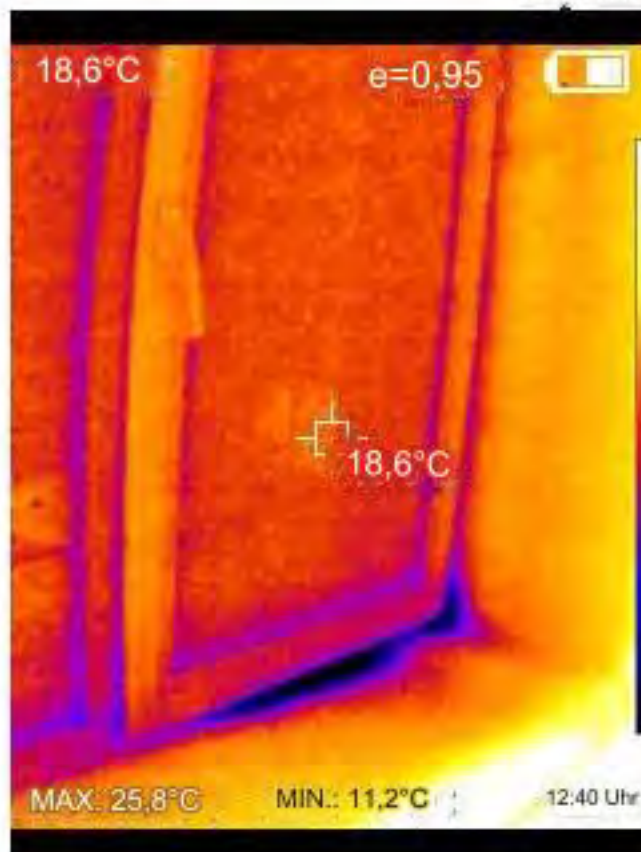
Fenster mit Doppelverglasung vom Typ 4-10-4-10-4.
